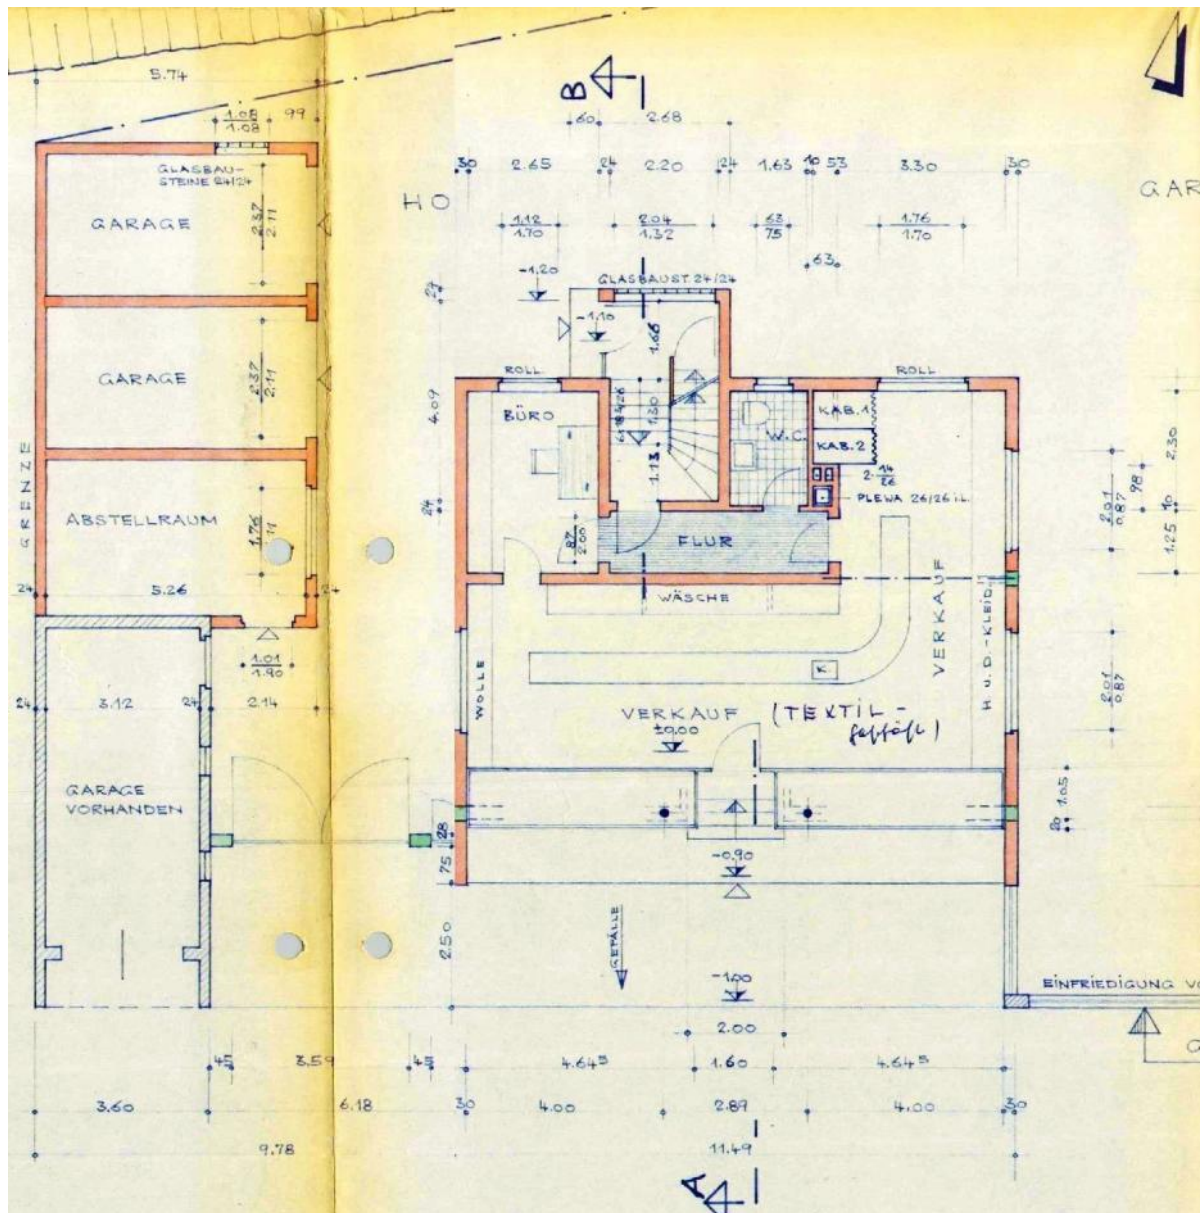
Grundrissplan Erdgeschoss des Ursprungsgebäudes (aus Bauakte 1962)
